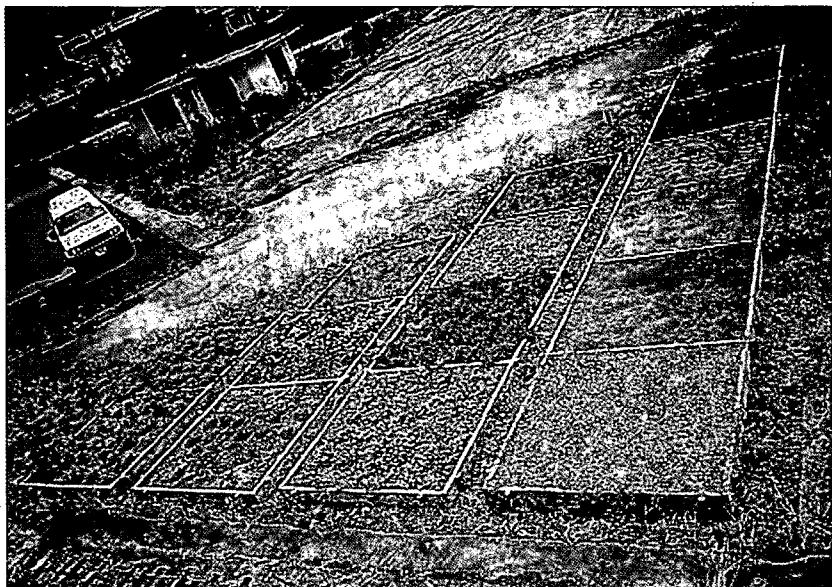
小規模植生実験の概観（施工後 14 箇月経過）
